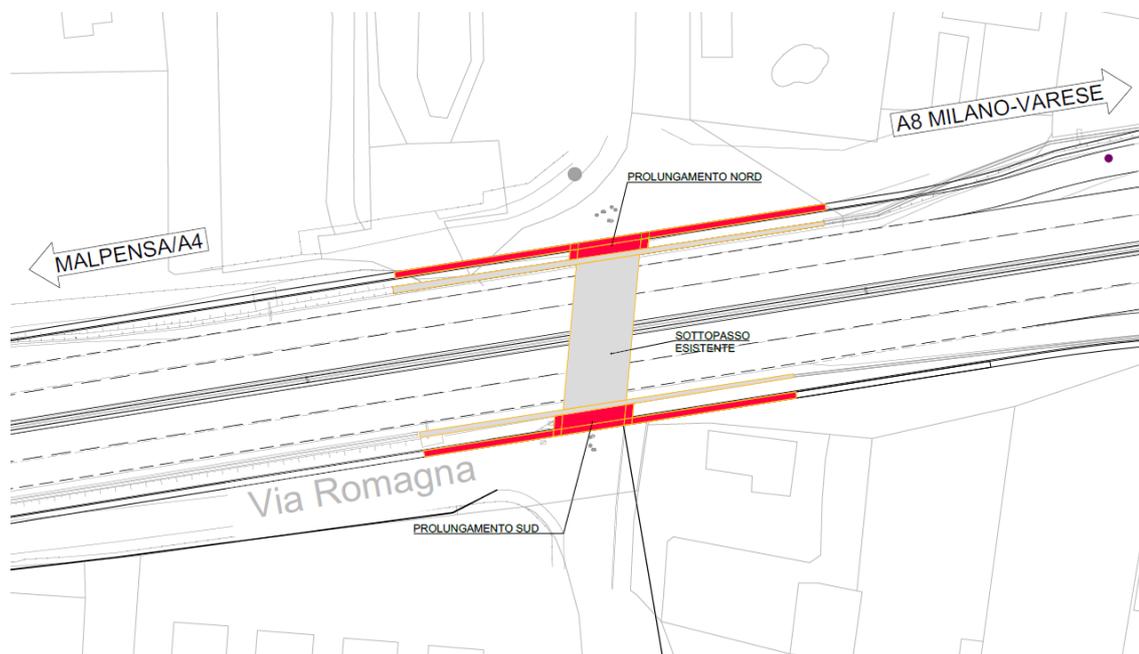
Stralcio planimetrico sottopasso via Correnti
